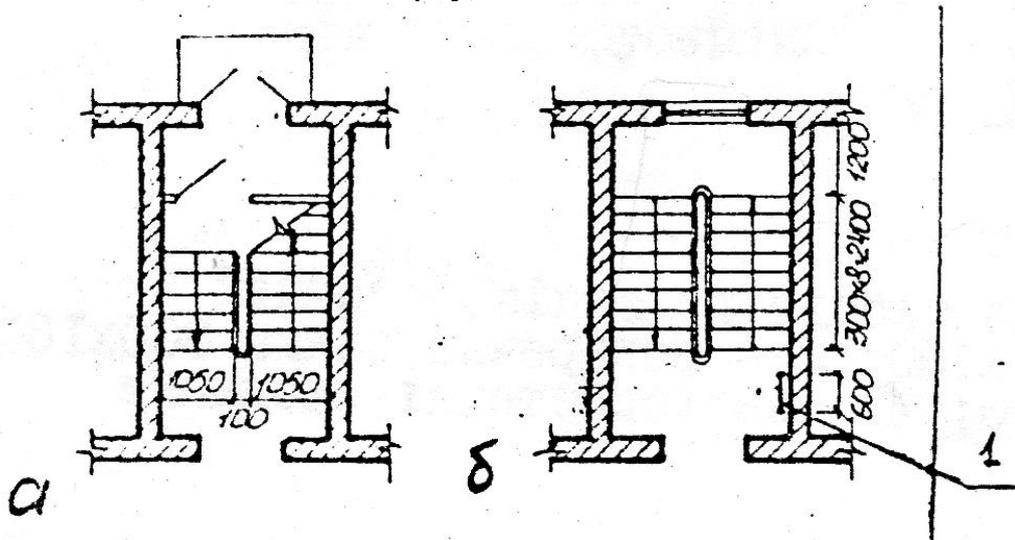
Сходова клітина: а – на плані першого поверху;
